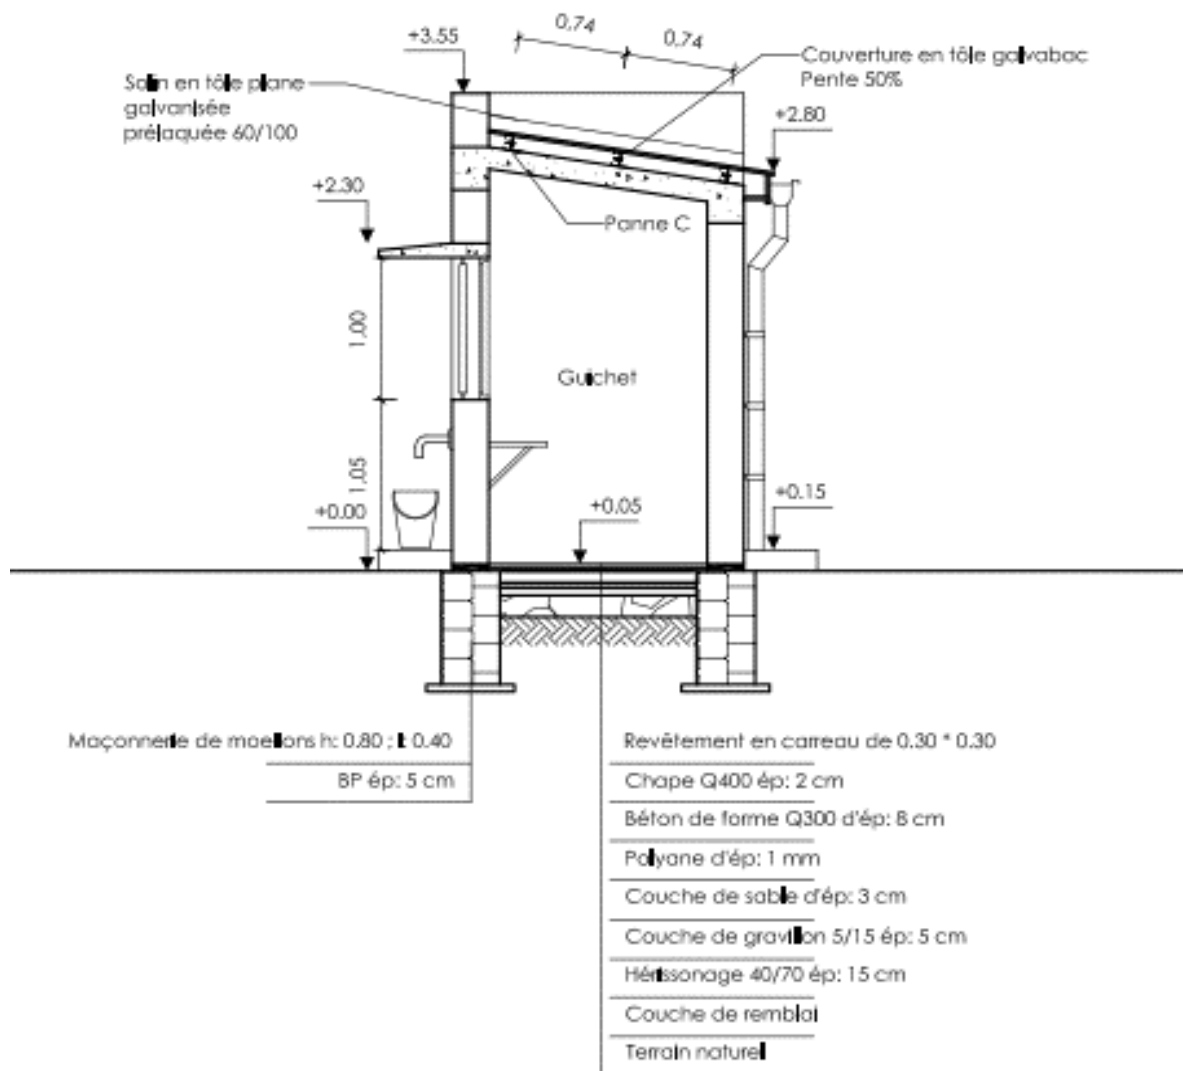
Schéma en coupe type d'une borne fontaine
